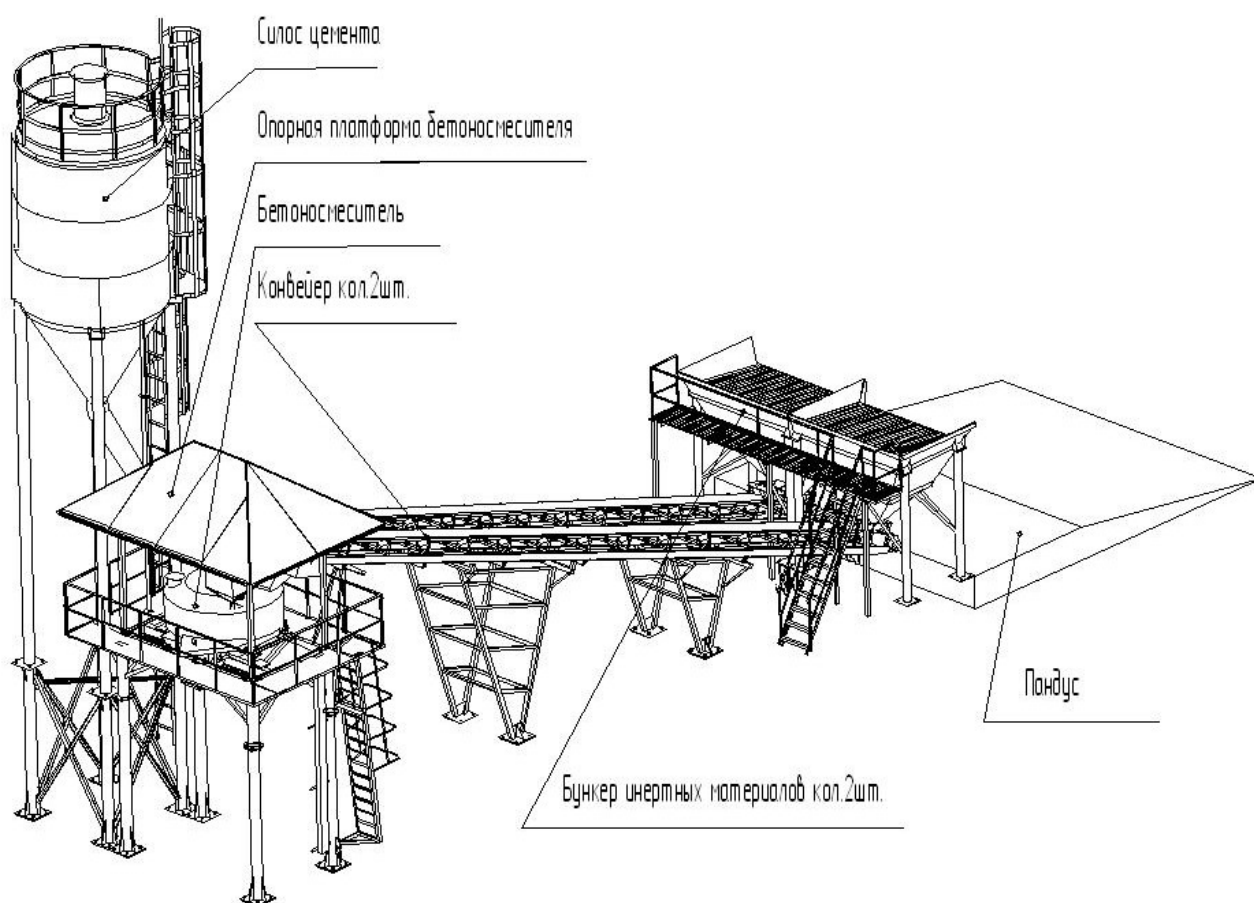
Установка для приготовления бетонной смеси СБ-138
